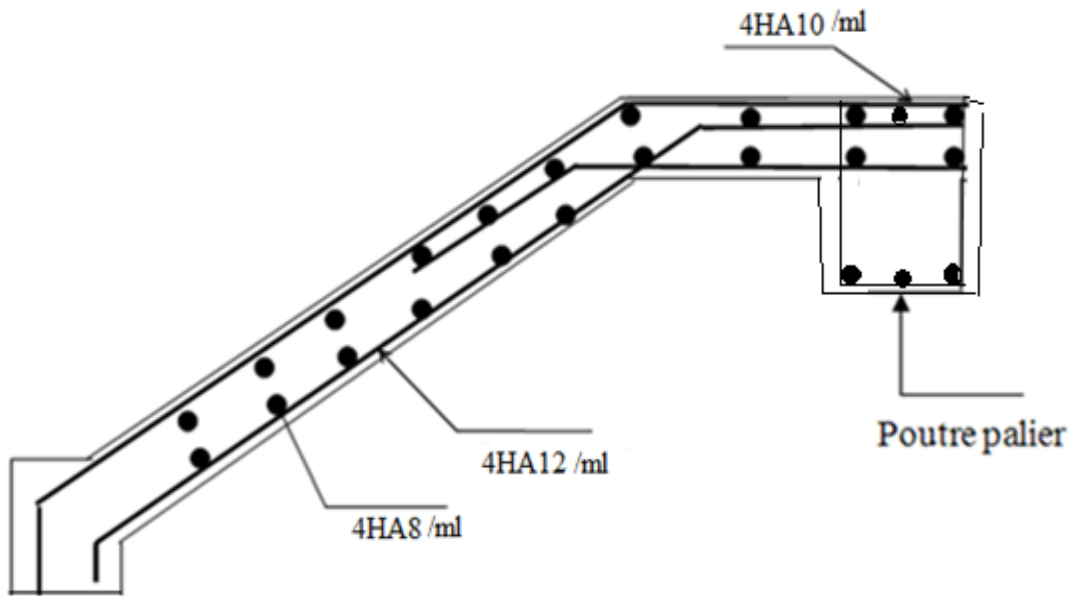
Schéma de Ferrailage de l'escalier de l'entre sol (volée 1 et 3)
